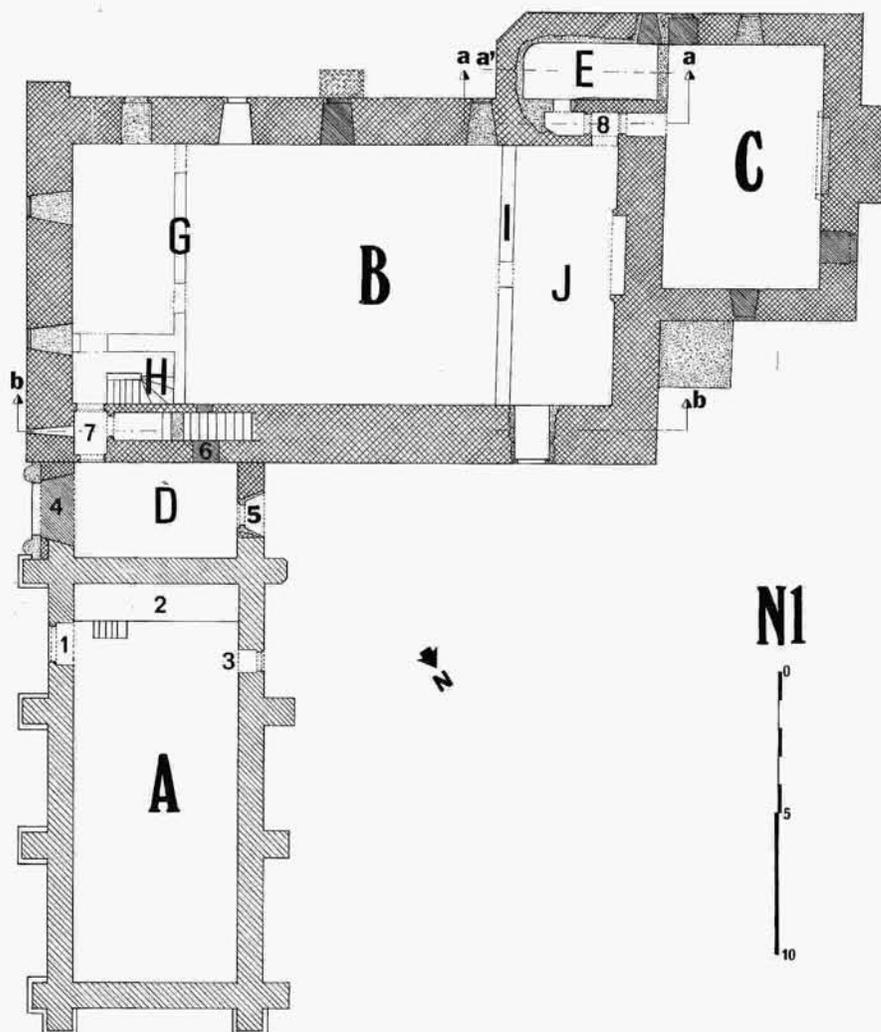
PLAN DES BÂTIMENTS DU « DONJON » AU NIVEAU 1
